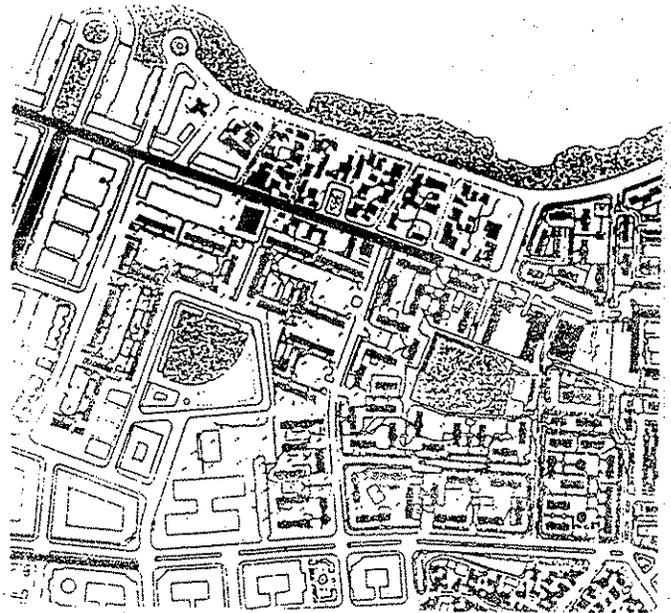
Sistema de Energía Eléctrica Propuesto en Barriadas
